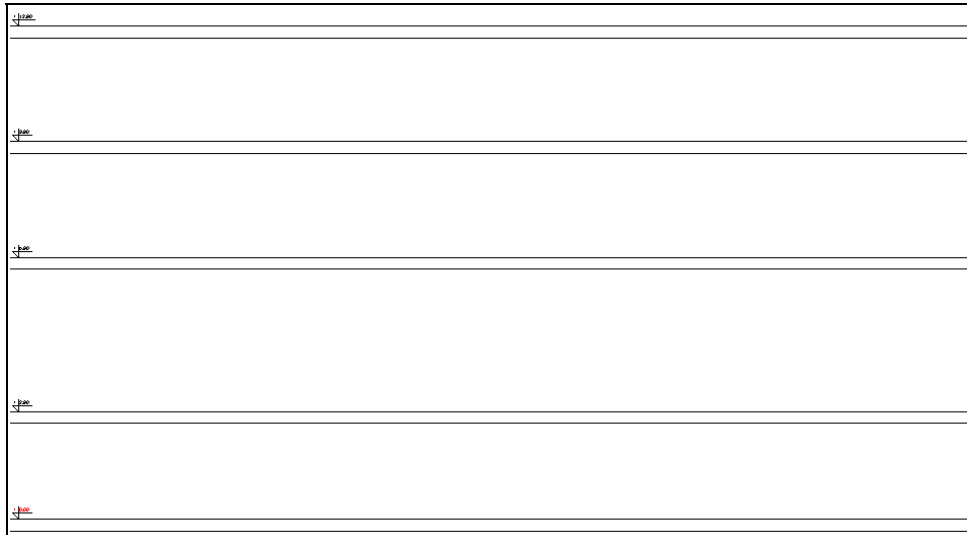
Фрагмент схемы с нарисованными перекрытиями
